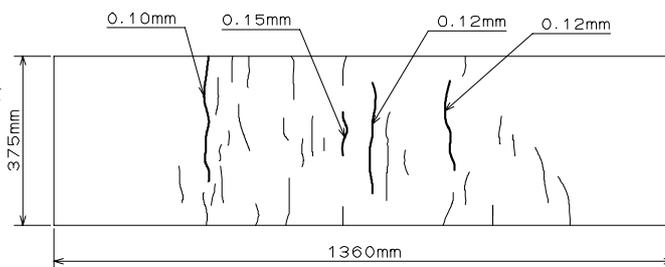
最終ひび割れ図(最大荷重 90kN 除荷時)
